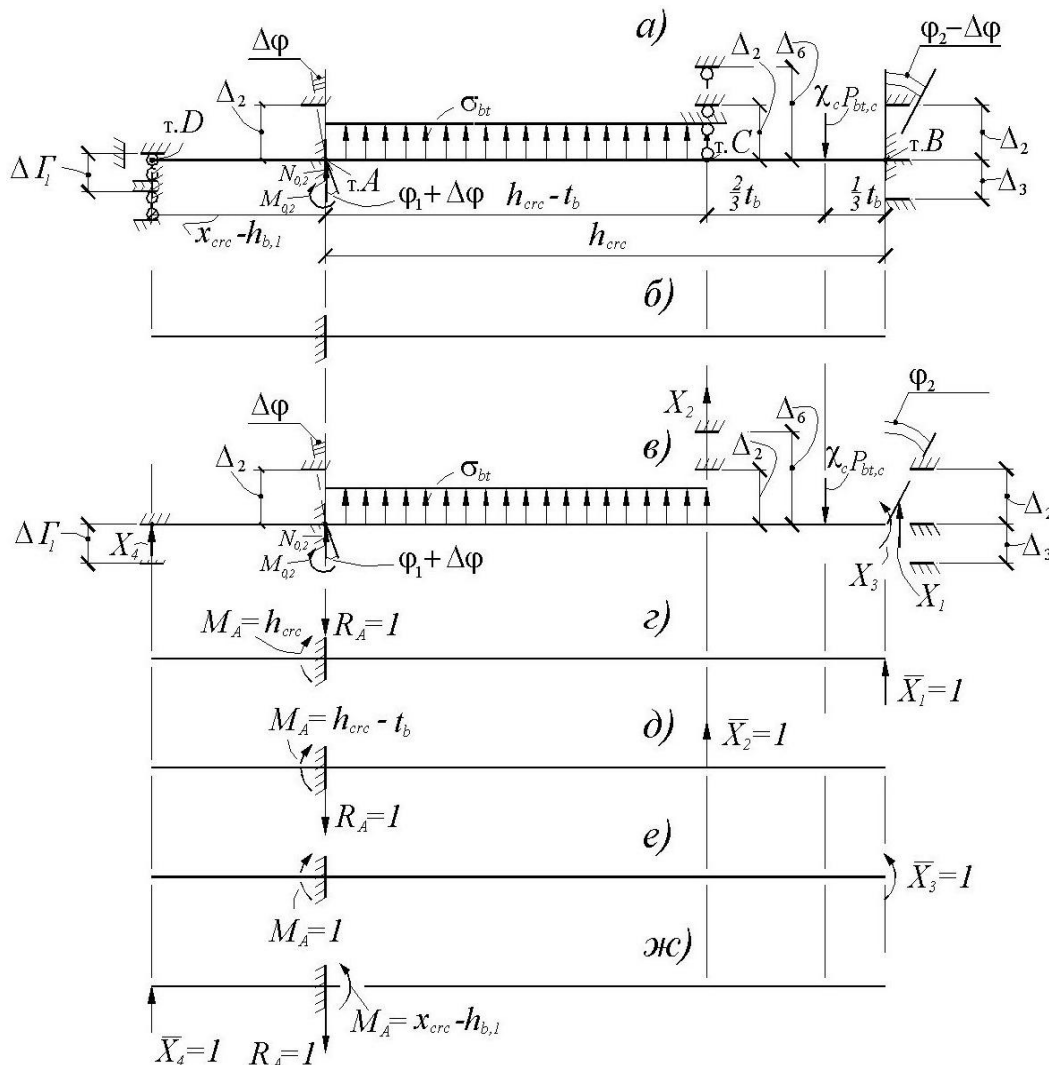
Построение расчетной схемы для раскрытия статической неопределенности ДКЭ при внецентрированном сжатии составного железобетонного стержня в зоне, прилегающей к трещине: а – расчетная схема; б – основная система; в – эквивалентная система; г-ж – определение реакций от единичных состояний
